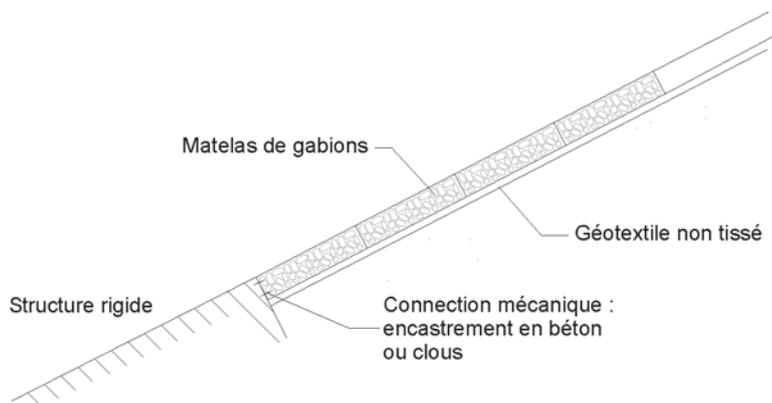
Transition entre un revêtement en gabions et une structure rigide
